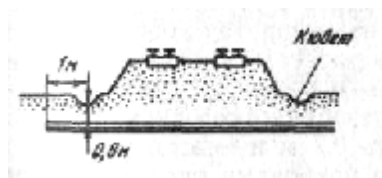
Прокладка труб на пересечении с железной дорогой.
